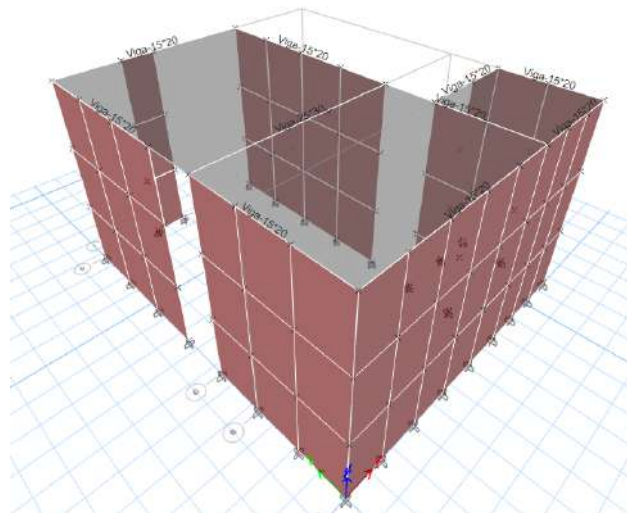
Vista en planta del modelamiento de la vivienda 09
